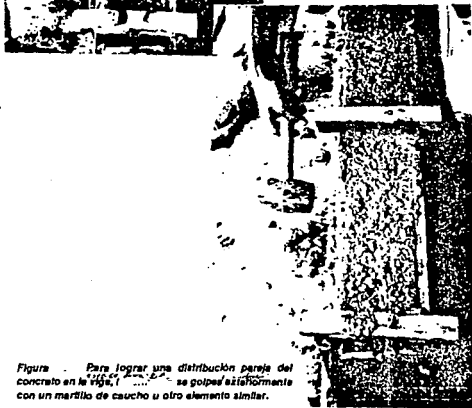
Para lograr una distribución pareja del concreto en la viga se golpea vigorosamente con un martillo de caucho u otro elemento similar.
